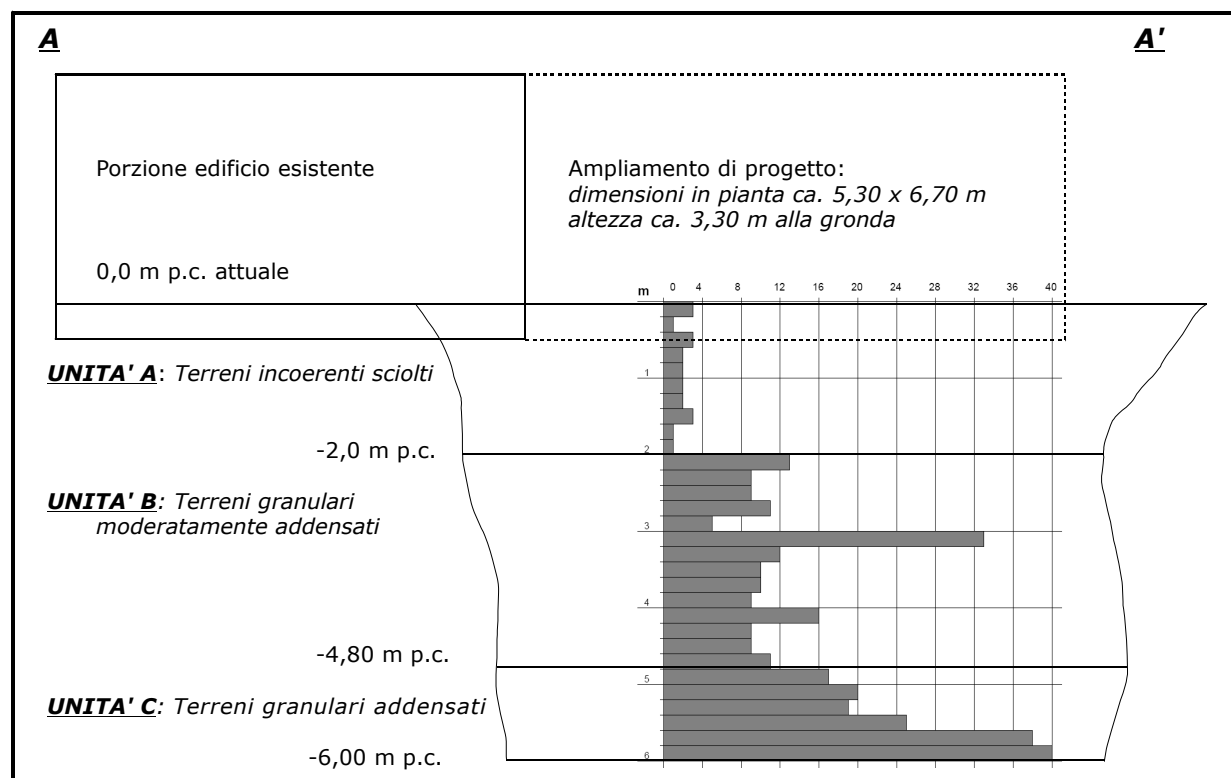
Sezione geotecnica schematica dei terreni di fondazione alla scala 1:100.
